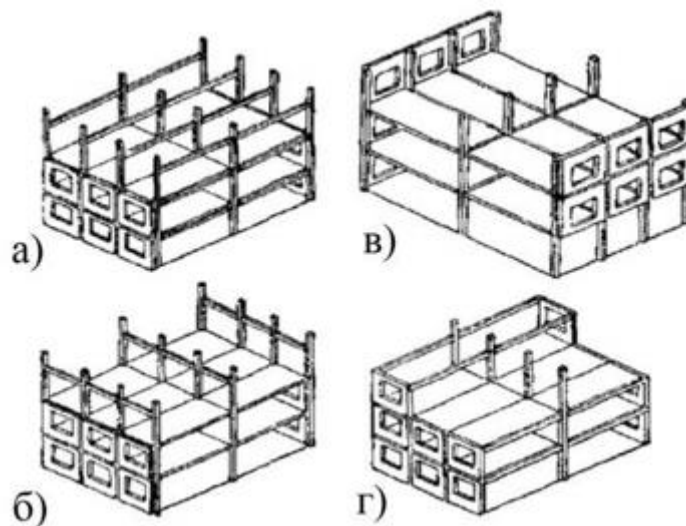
Конструктивні схеми каркасно-панельних будівель: а) з поперечним каркасом; б) з поздовжнім каркасом; в) з безригельним перекриттям, опертим на чотири точки; г) з неповним (внутрішнім) каркасом і панелями зовнішніх несучих стін
